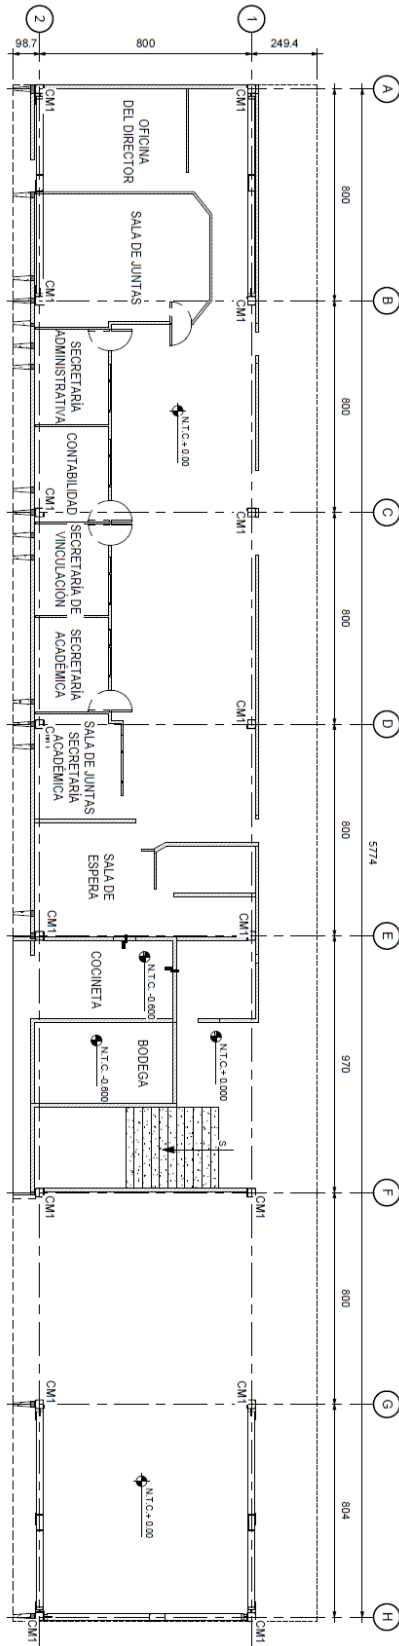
Planta arquitectónica baja. Fuente autoría propia, 2023.
